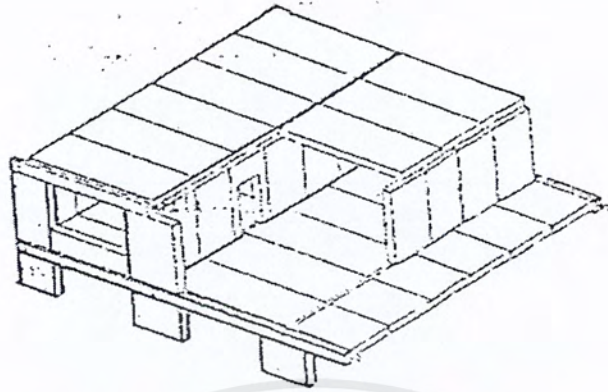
ระบบ Cross – Wall แสดงการวางผนังด้านหน้าซ้อนรับน้ำหนักกันเอง
